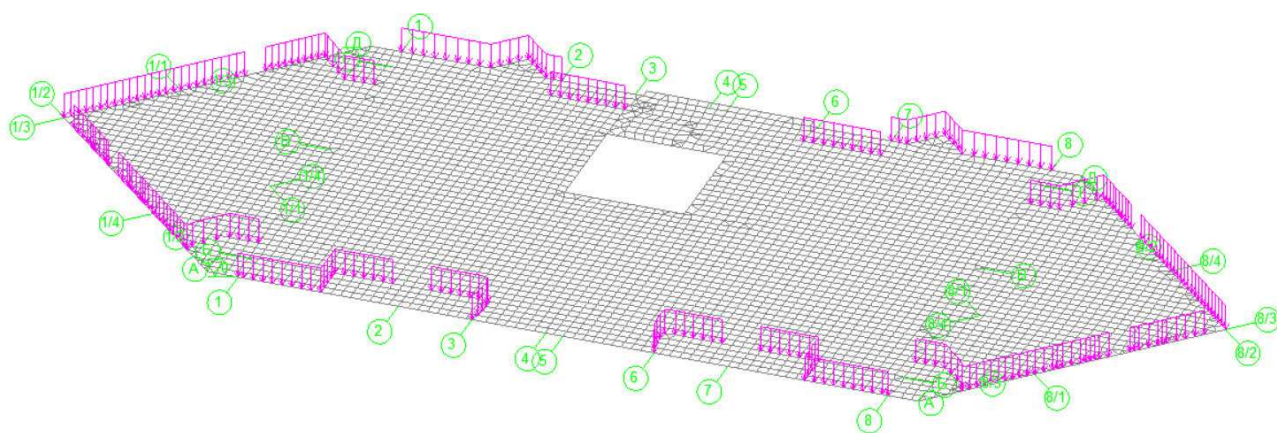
Загрузка плиты перекрытия весом наружных стен
